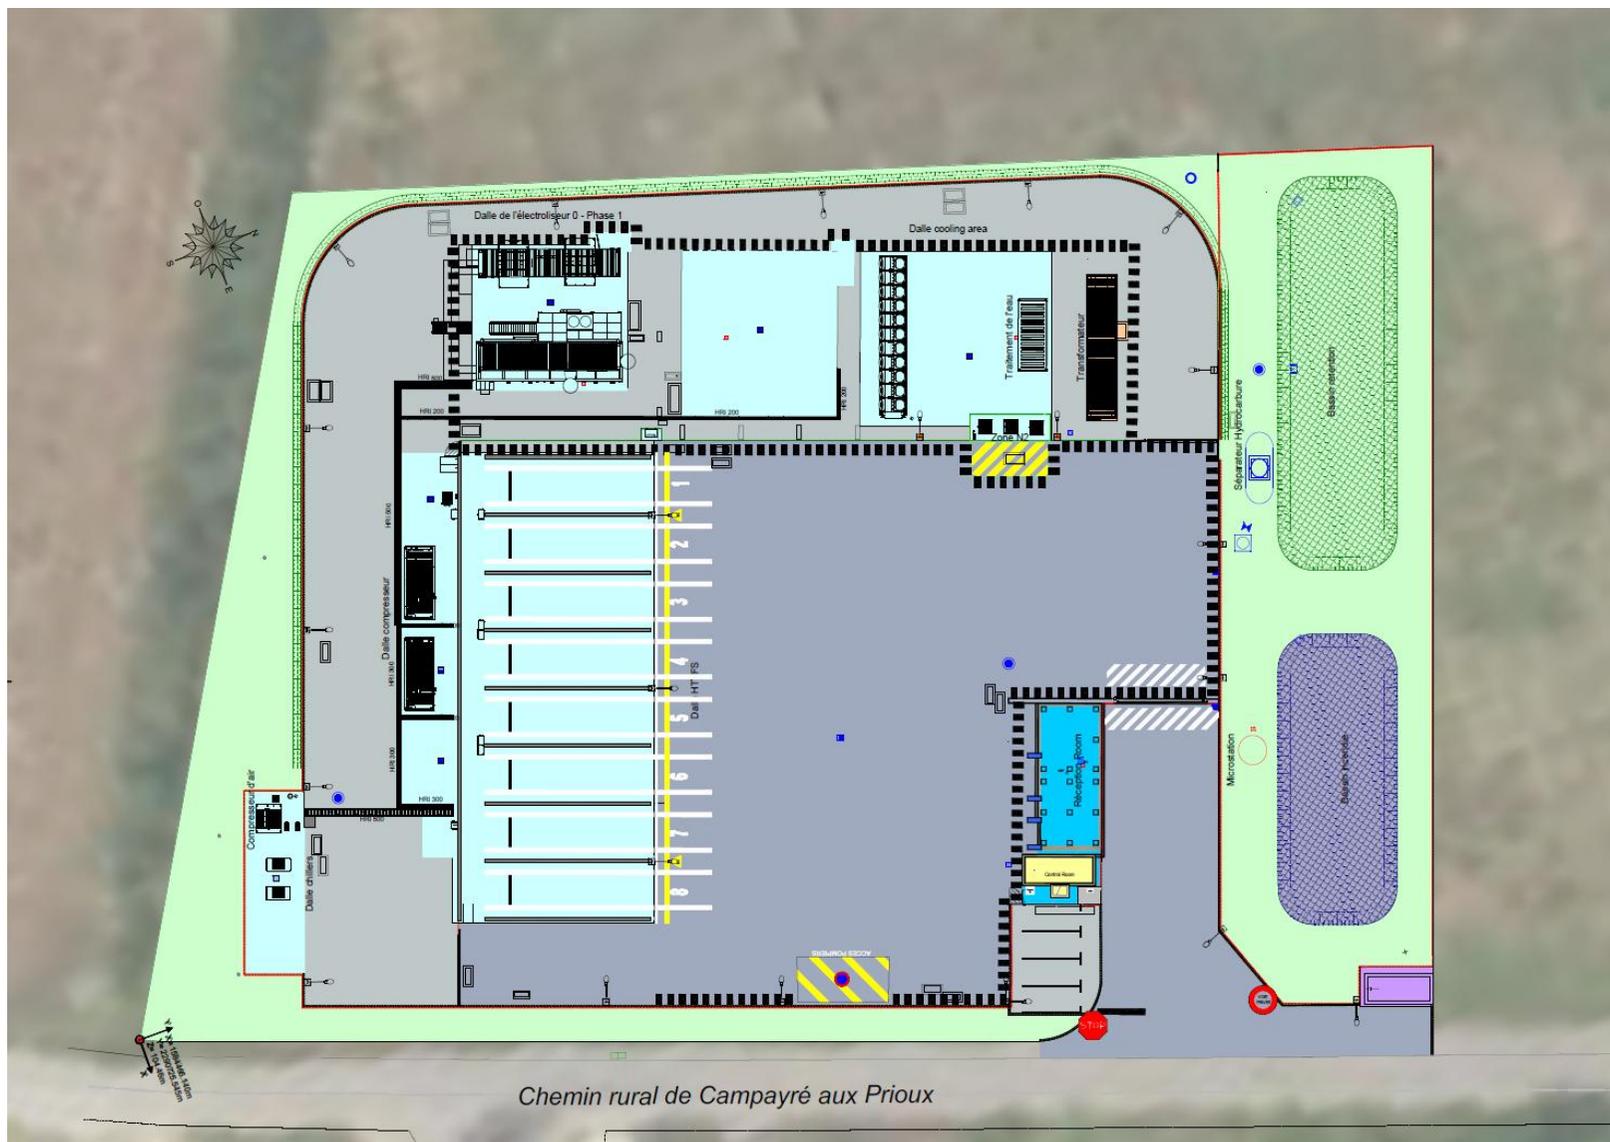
Plan de masse du site Lhyfe de Bessières - Echelle 1:400
